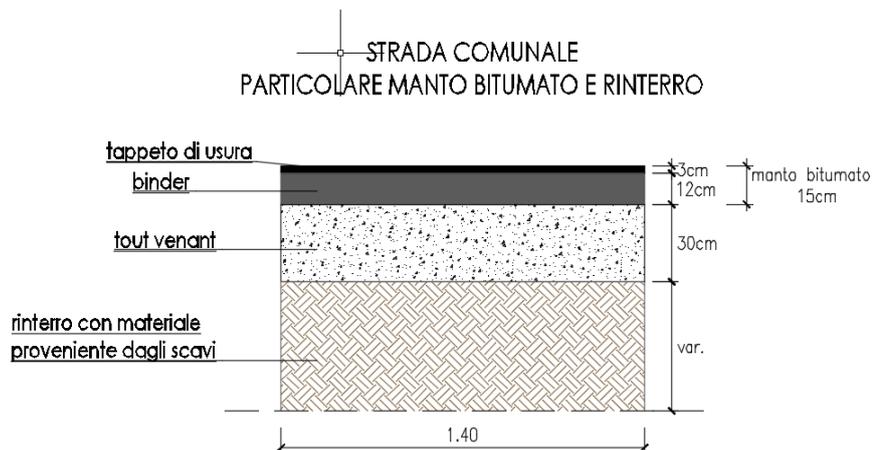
Sezione tipo 3 – particolare del rinterro e manto bitumato
